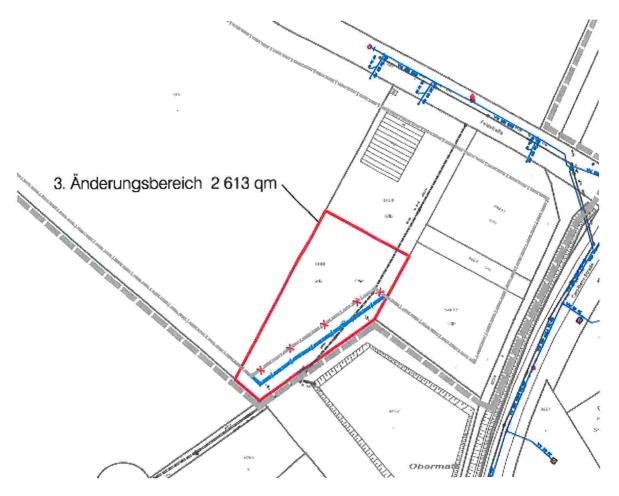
Bebauungsplan Entwurf zum Offenlagebeschluss
